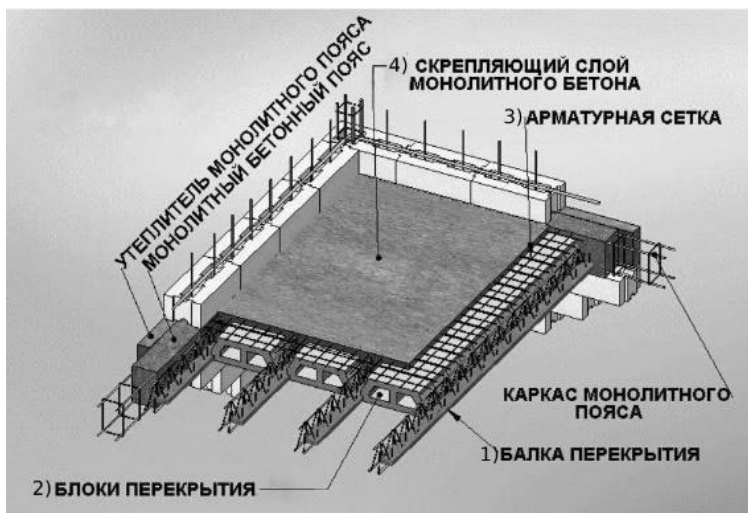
Общая конструктивная схема сборно-монолитного перекрытия: 1) балки со встроенным треугольным каркасом; 2) пустотельные блоки; 3) арматурная сетка; 4) слой скрепляющего монолитного бетона
